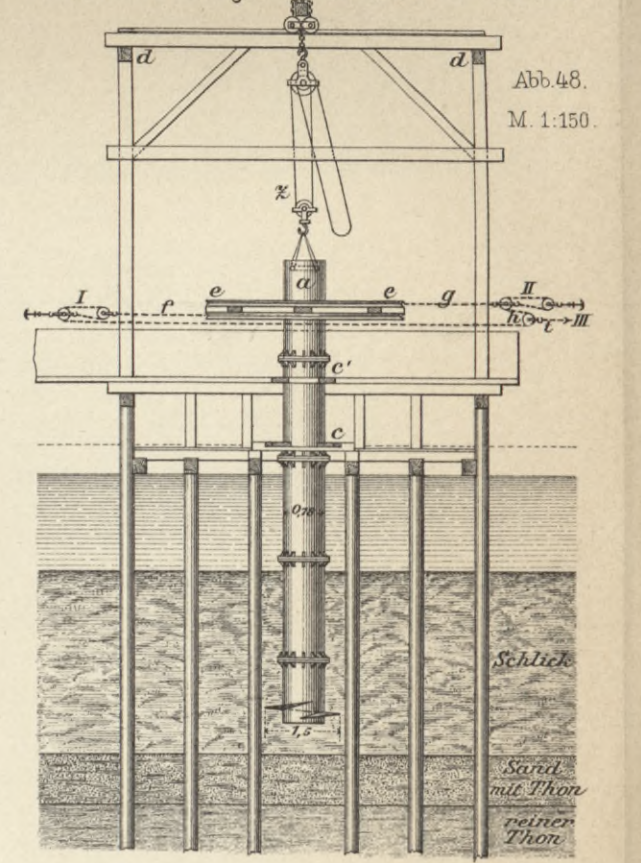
Gerüst u. Schraubvorrichtung zum Einschrauben der Pfähle von der Festungsgrabenbrücke der Königsberg-Labauer Eisenbahn.
